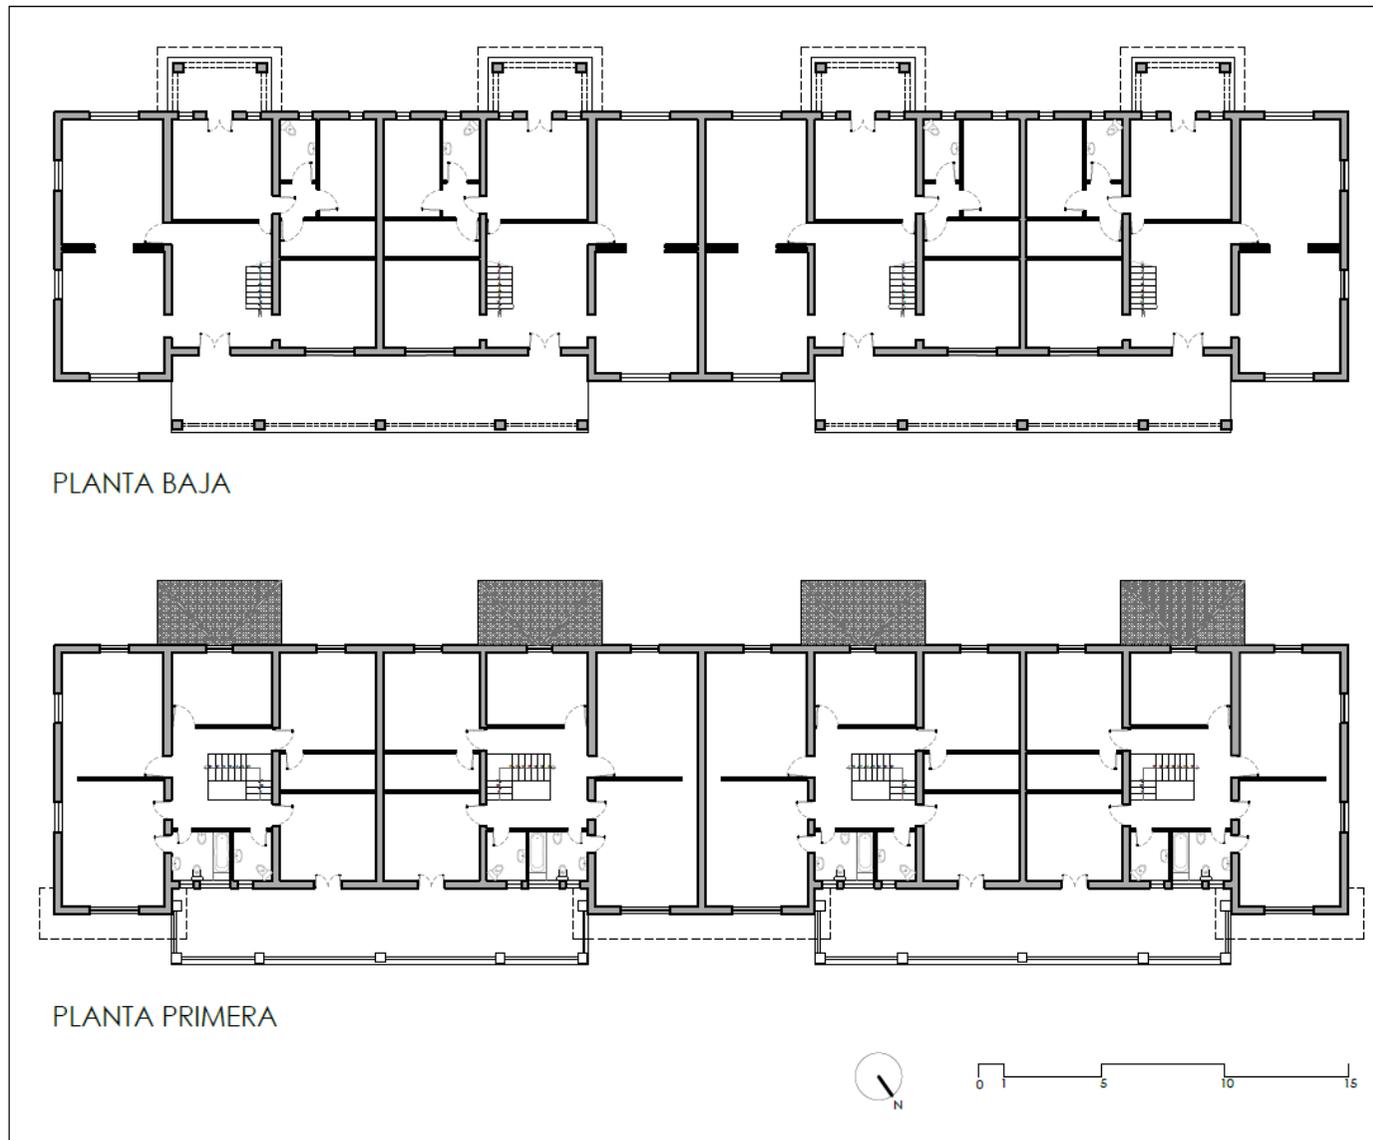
Planta baja y primera de bloque de casas chalet. Fuente: Elaboración propia a partir de la planimetría de Cormano García (2014), Fernández Pérez (2021) y del Plan Director del Patrimonio de Sagunto (2010).
